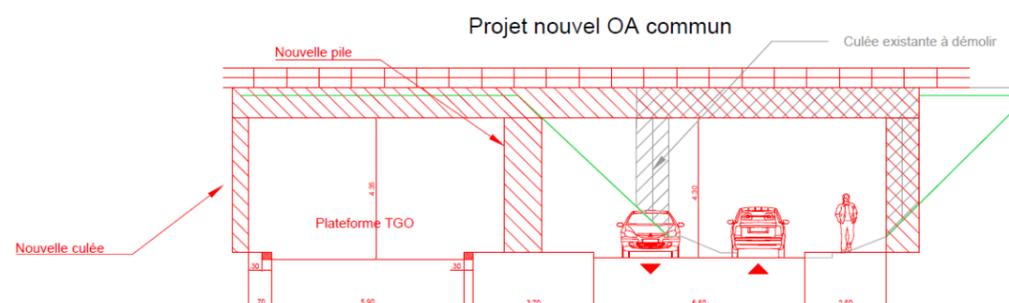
Coupe type du pont-rail d'Achères-Ville élargi
